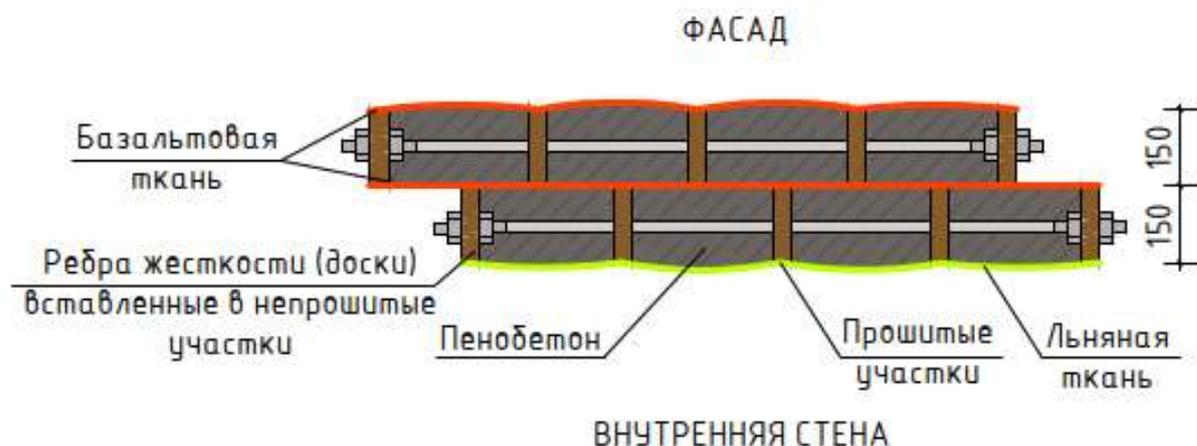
Конструкция тканевой несъемной опалубки, заполненной пенобетоном
